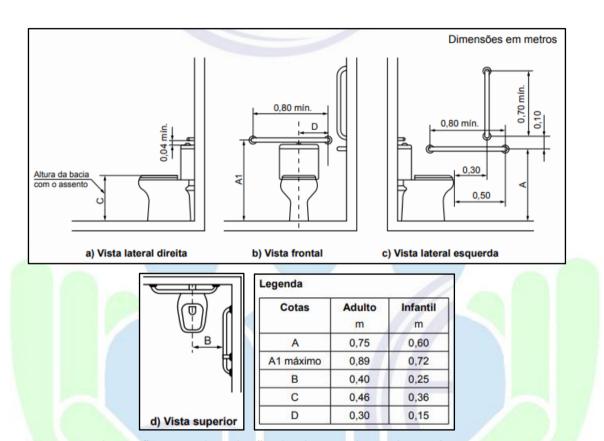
Dimensões para instalação das barras de apoio conforme NBR 9050/2020
